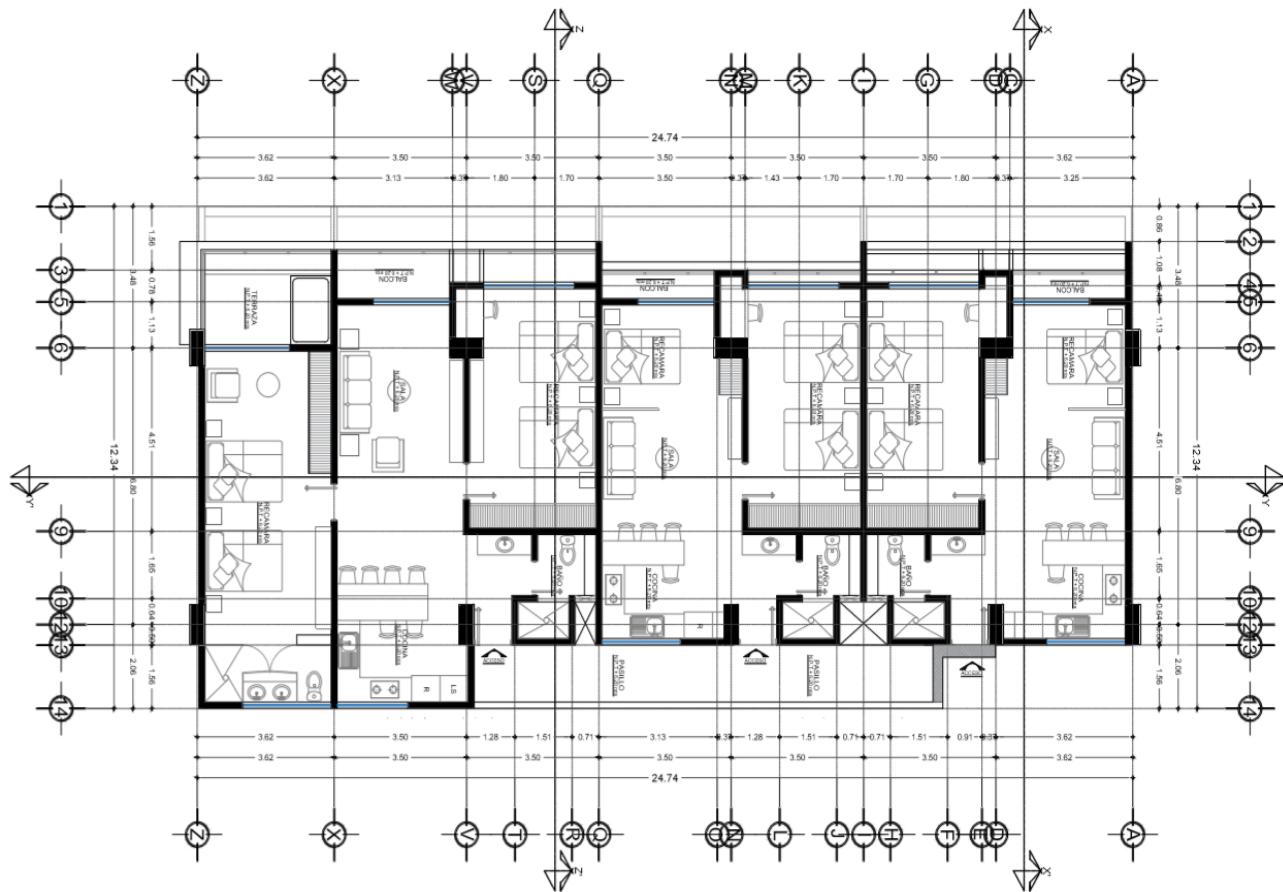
Planta arquitectónica del segundo nivel del Edificio A.
